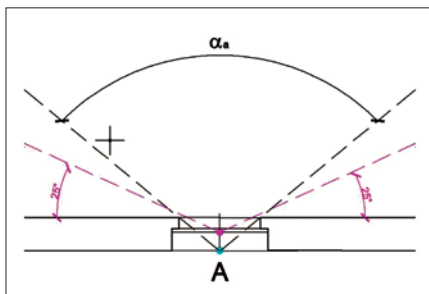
Kontrolní bod podle ČSN 73 4301 Obytné budovy [3]
